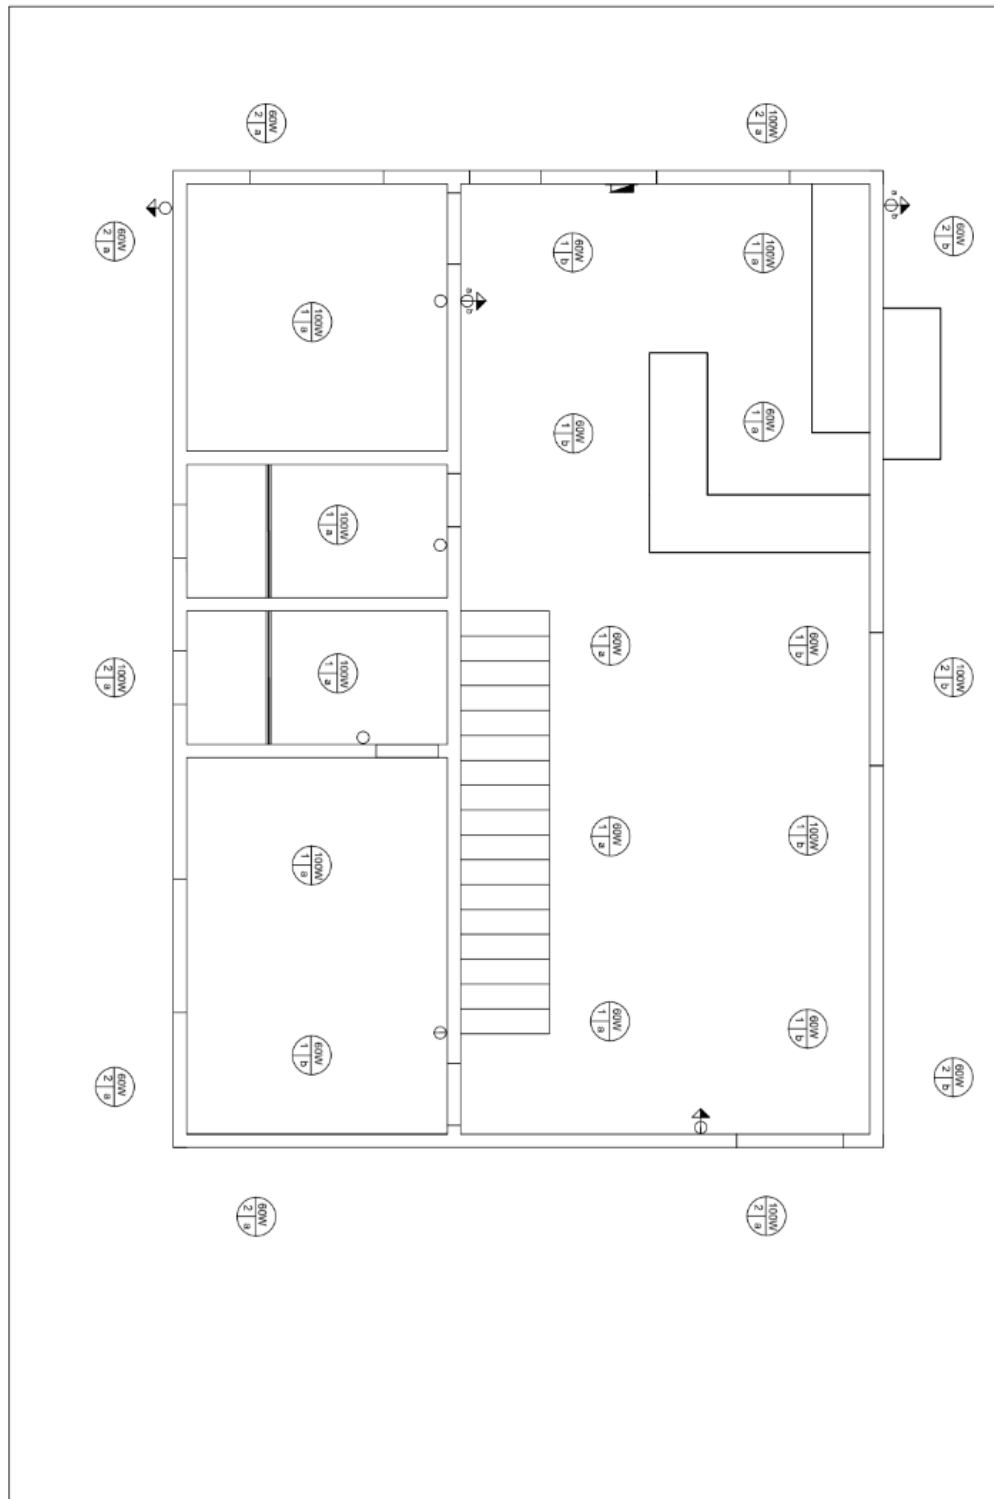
Planta Baixa de Iluminação Pavimento Térreo
